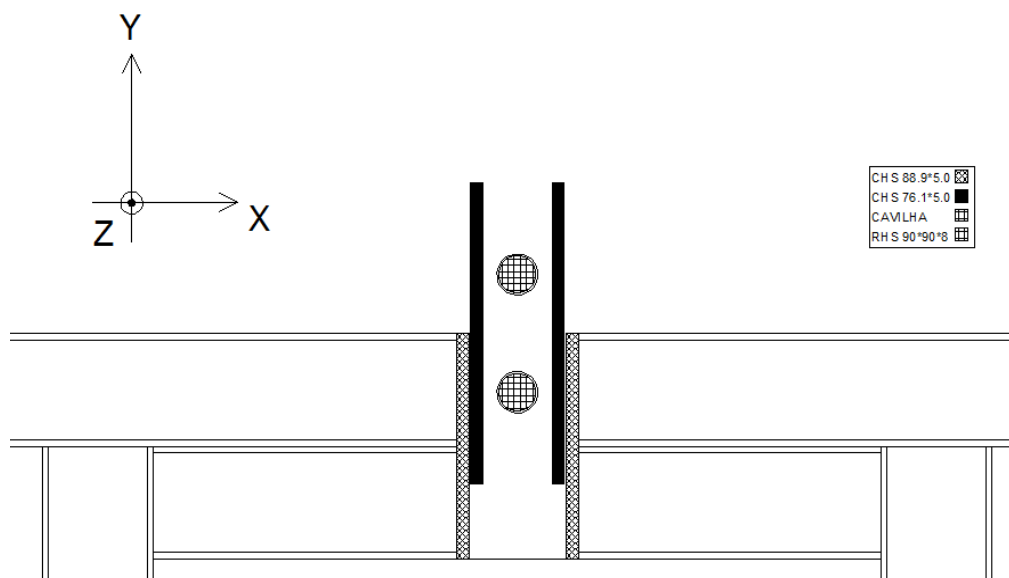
Pormenor da alteração da ligação do suporte de terras e mastro
